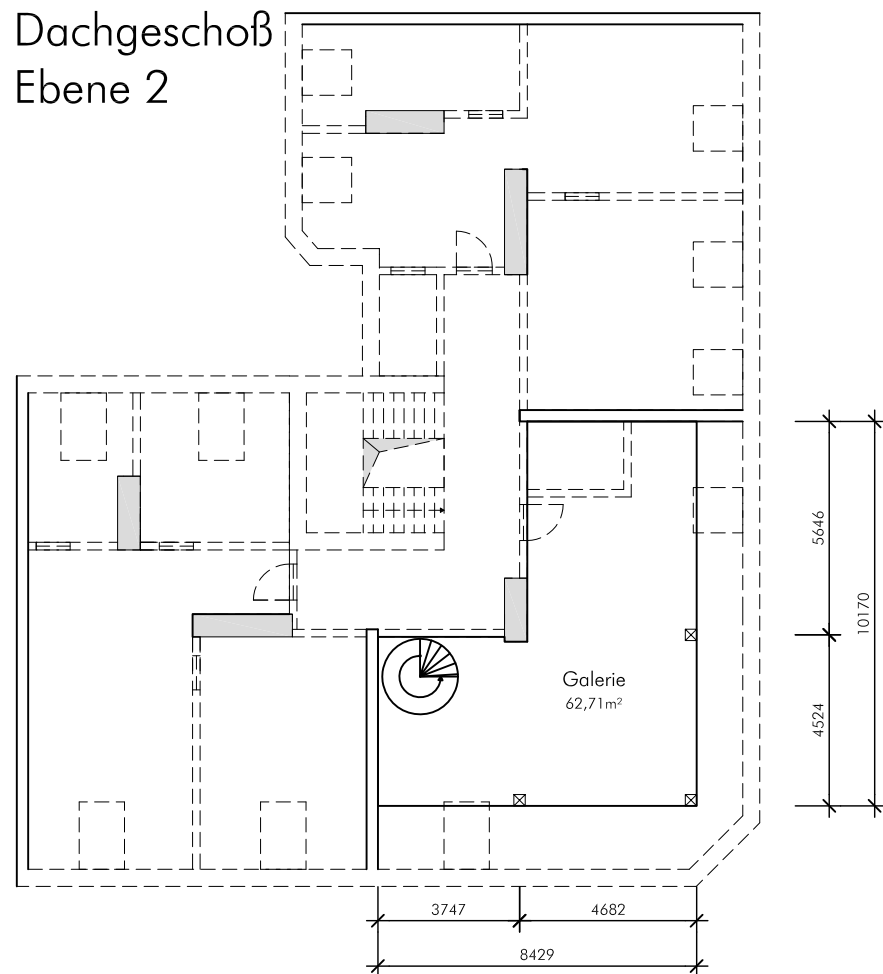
Grundriss Dachgeschoss Ebene 2 M 1:200 (Maße in mm)
